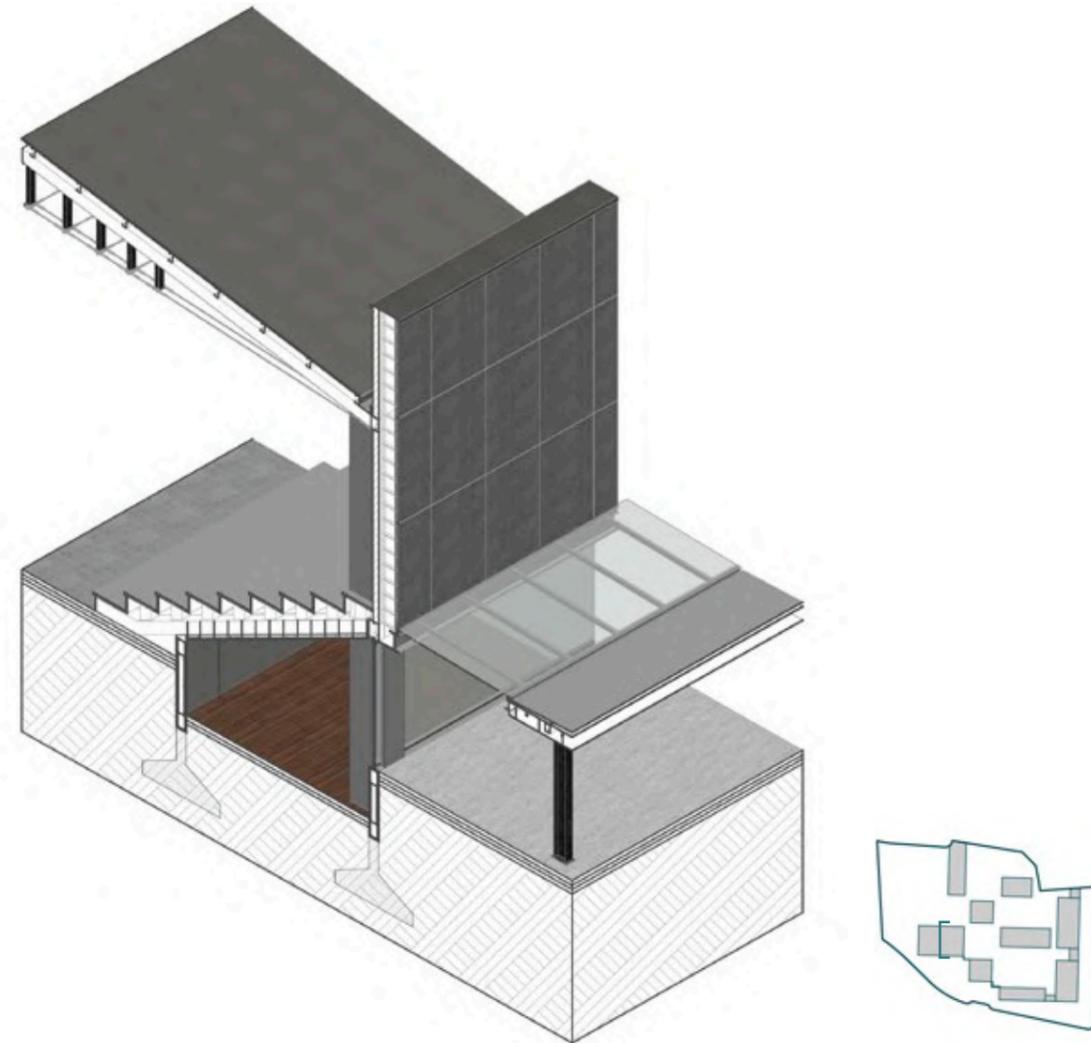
| Elevación, sección y detalles coliseo | Fuente: Elaboración Propia
